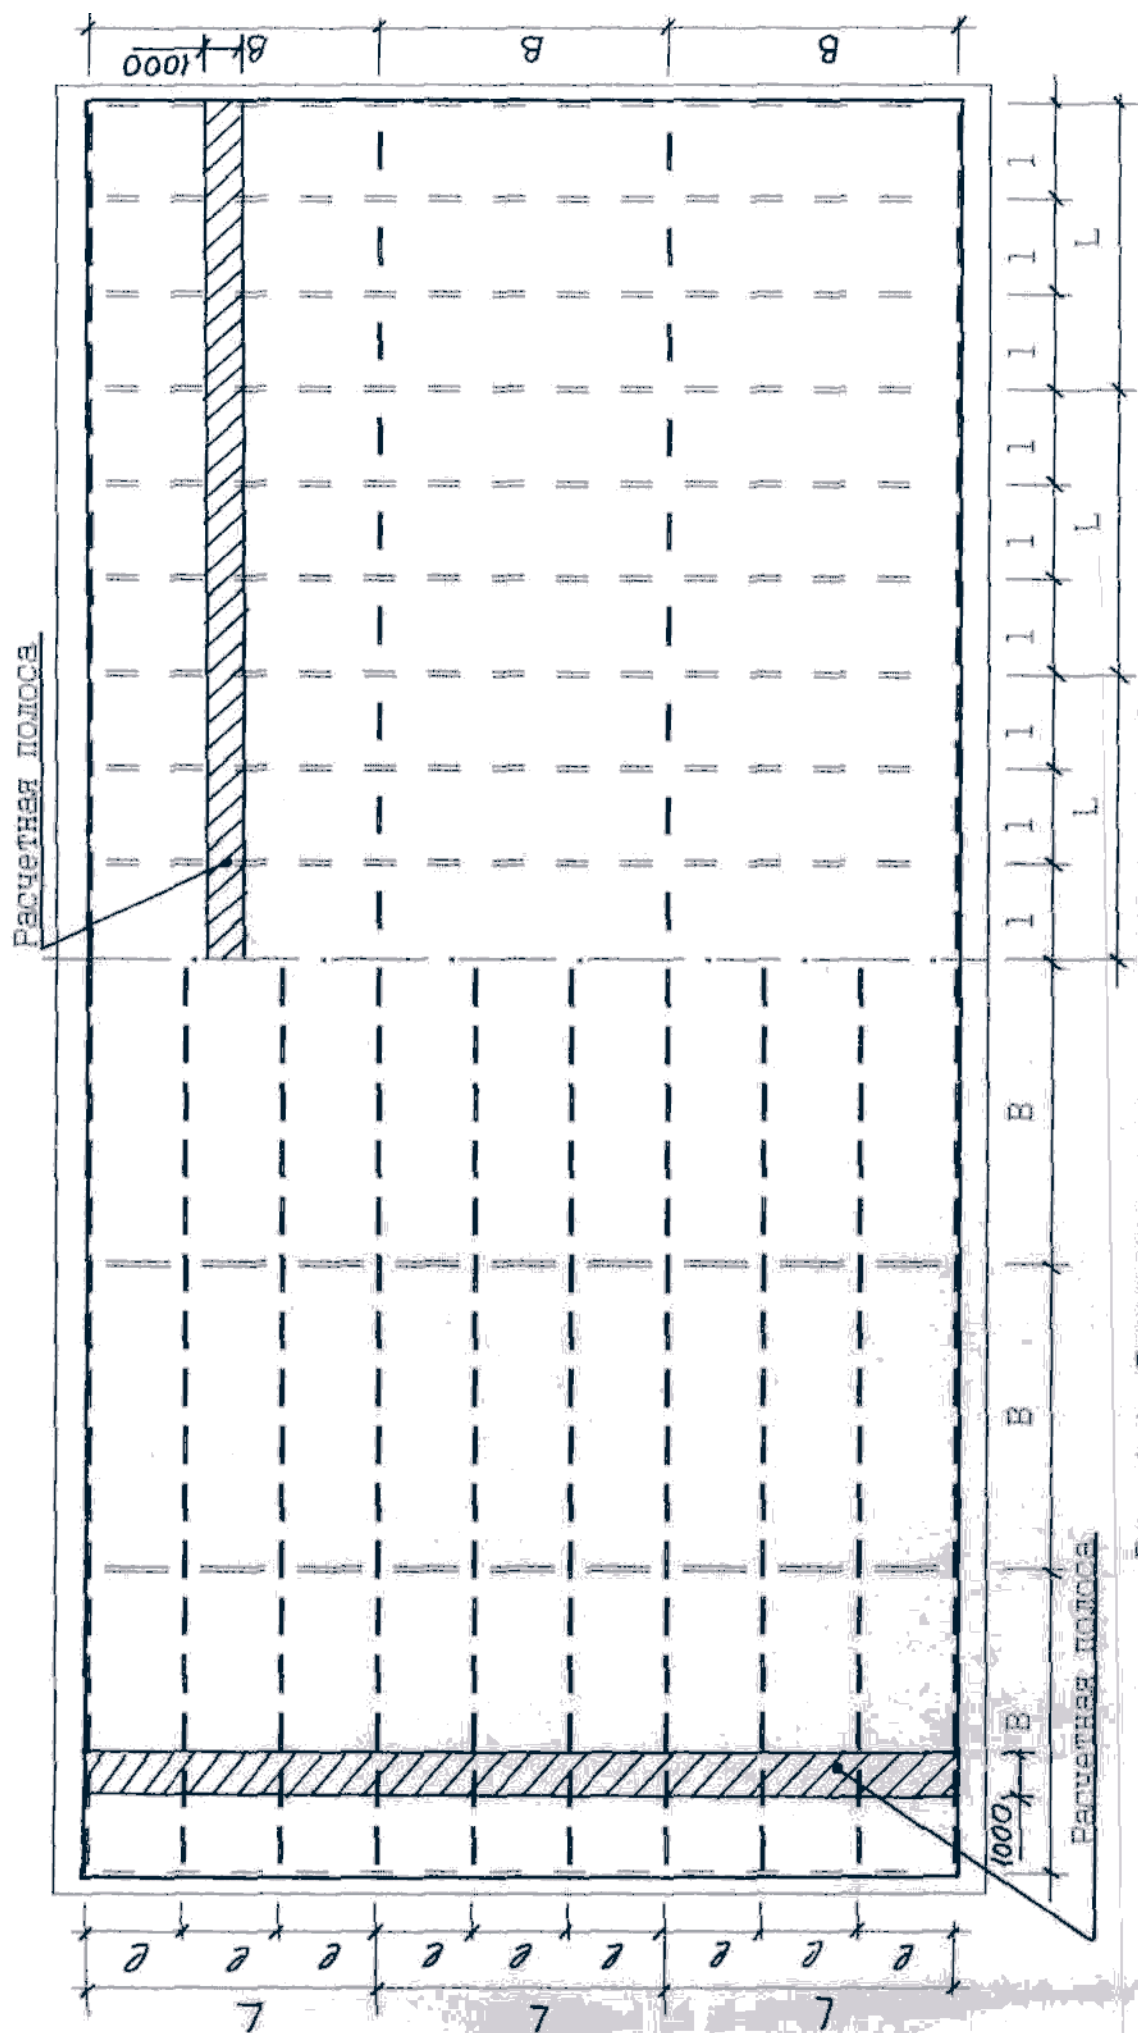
Расчетное монолитное перекрытие с балочными плитами
